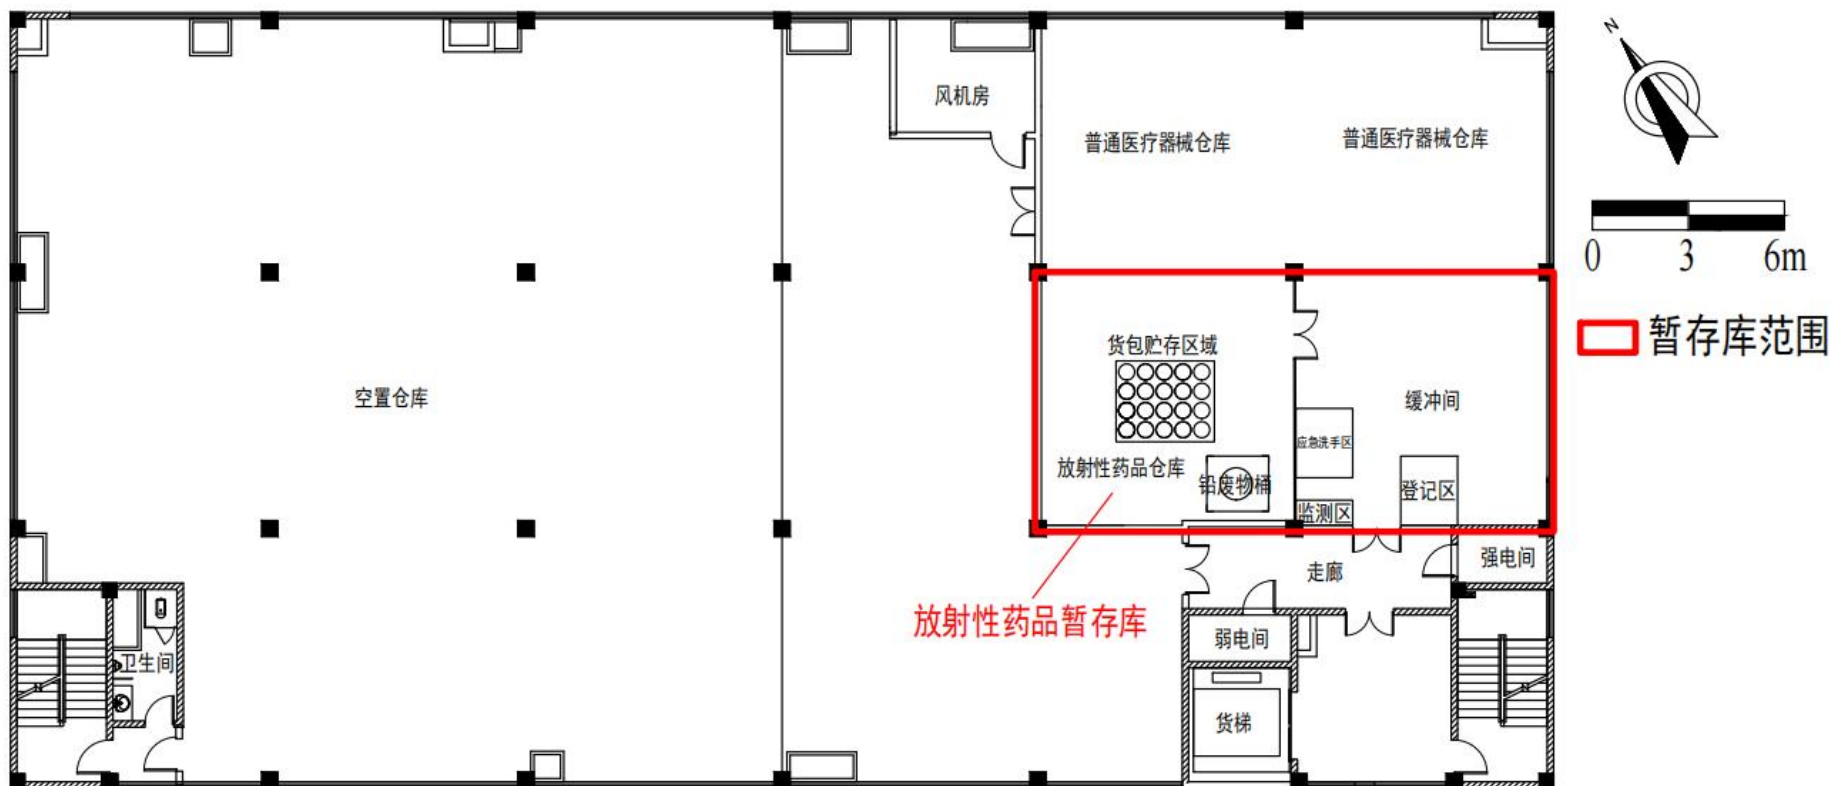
原子高科公司放射性药品暂存库所在楼层（五层）平面布置图
